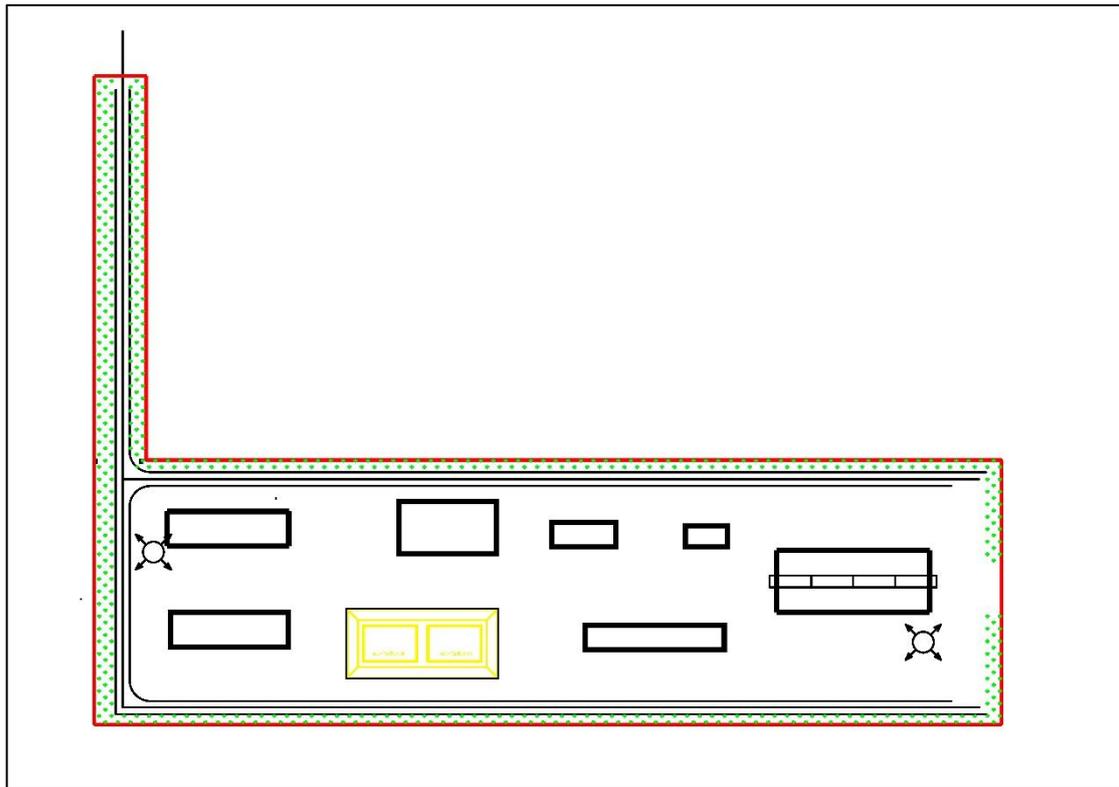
(1) 绿化平面布置图 (翻车机房区)
